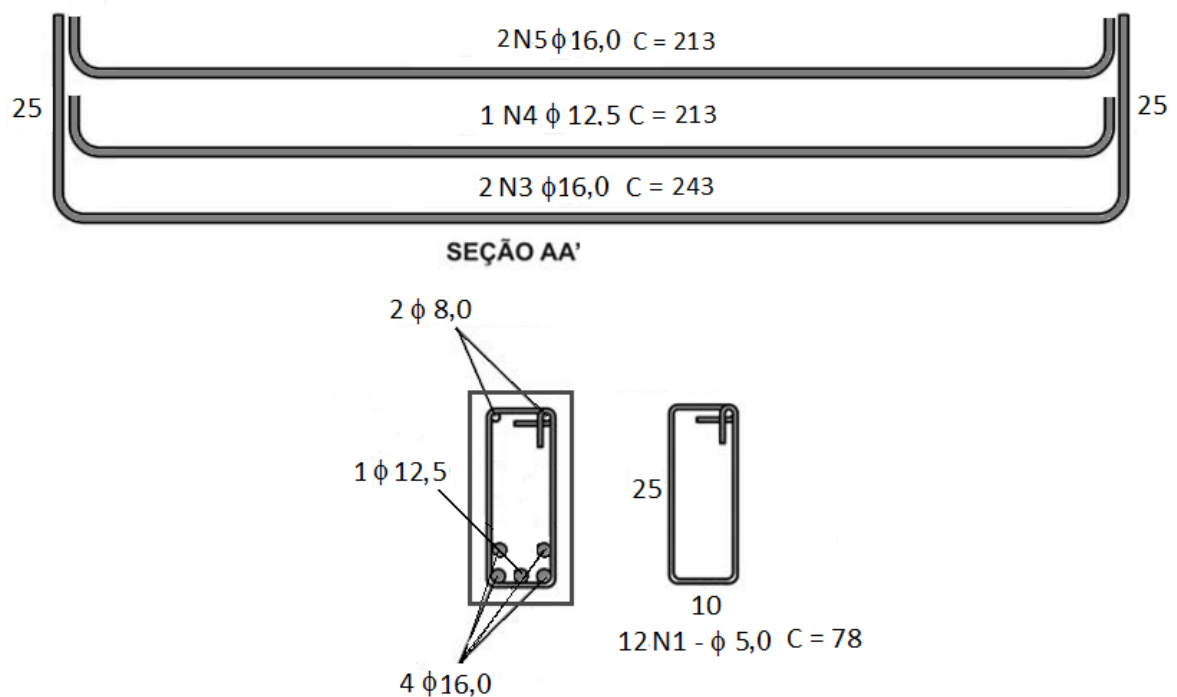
Armaduras das vigas do Tipo 3 (dimensões em centímetros, exceto diâmetros que estão em milímetros).
